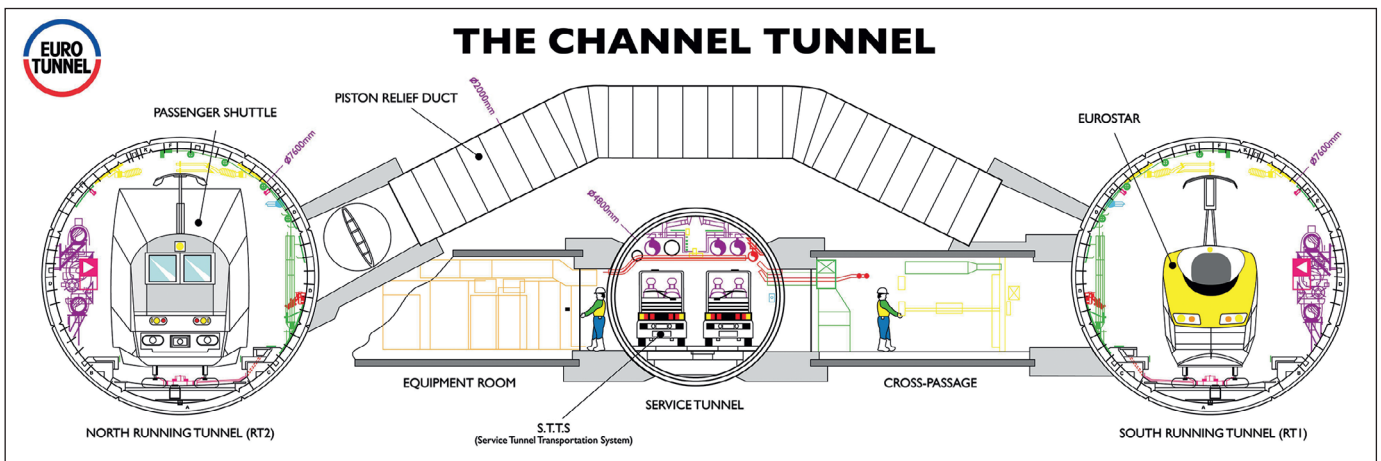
Tunnelsystem Euro Tunnel (Frankreich/UK) mit mittigem Servicetunnel und Querschlägen (alle 375 m) und Druckausgleichsverbindungen (Grafik: Eurotunnel)
